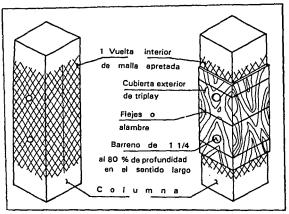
BARRENADO Y PROTECCION EN COLUMNAS DE CONCRETO
